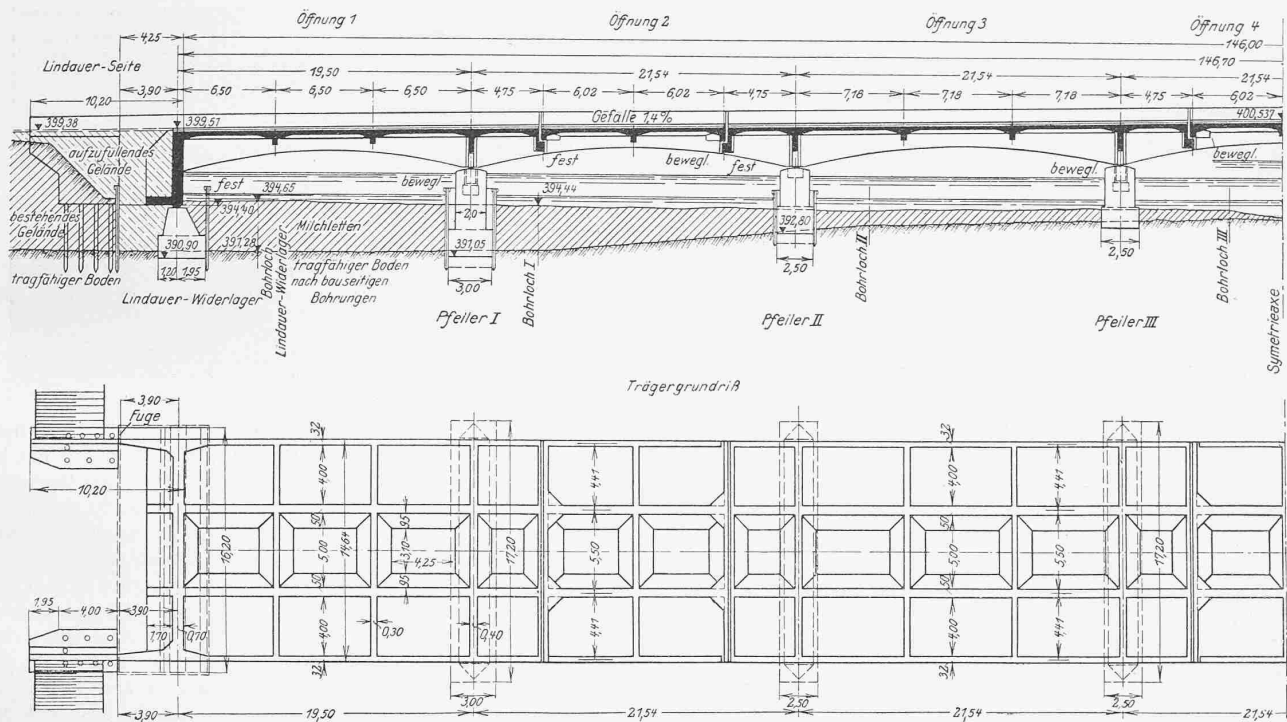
Längsschnitt und Grundriss der neuen Seebücke von Lindau. — Masstab 1 : 450.
